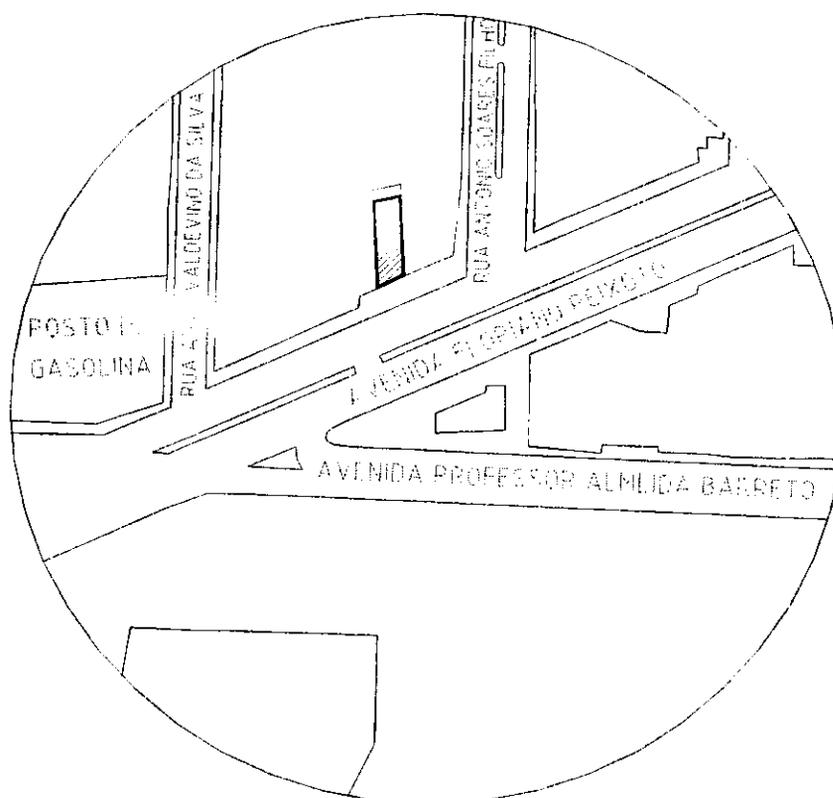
Planta de situação do Prédio multifuncional sito na Avenida Floriano Peixoto.
